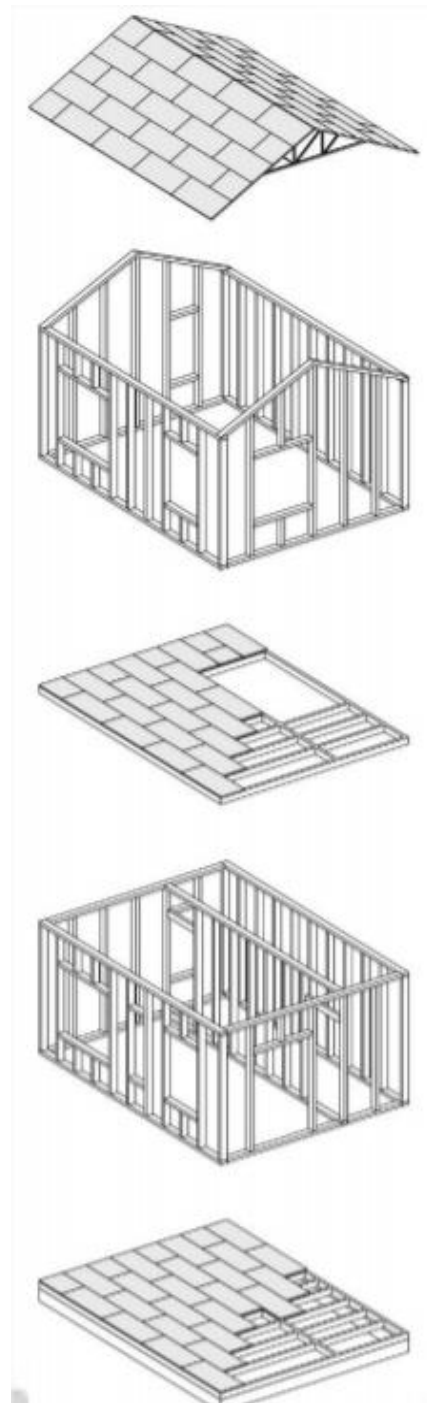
Sistema Construcción plataforma, fuente: PALMA, 2008
